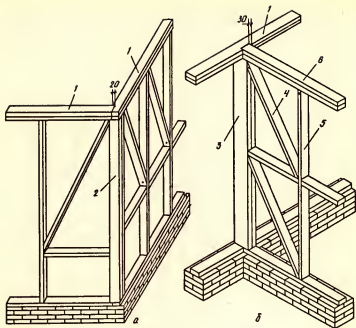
Элементы каркаса наружных (а) и внутренней (б) стен: 1 и 6 — верхние обвязки наружных и внутренней стен; 2 — угловая стойка; 3 и 5 — стойки внутренней стены; 4 — подкос
